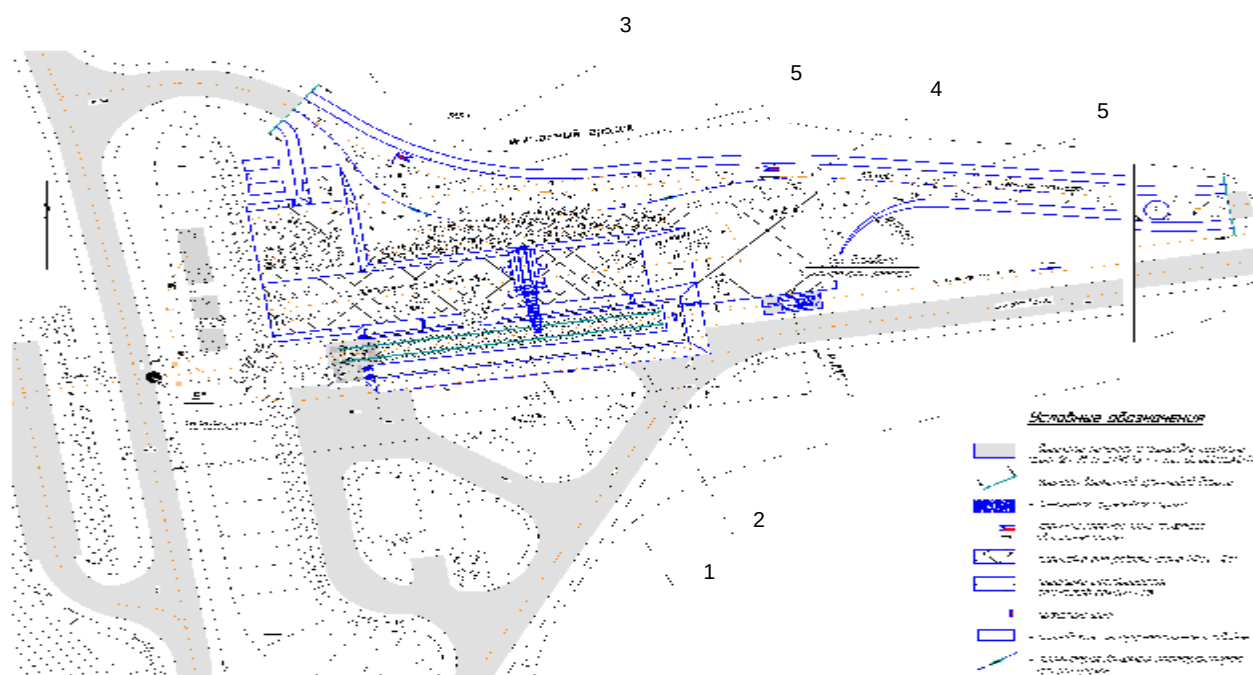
Схема организации монтажной площадки на борту карьера Мурунтау (отм. +555.0): 1 - стенд сборочный; 2 - рабочая площадка крана МКГС-100; 3 - площадка складирования конструкций; 4 - площадка складирования материалов и конструкций; 5 - временные автодороги и подъездные пути
